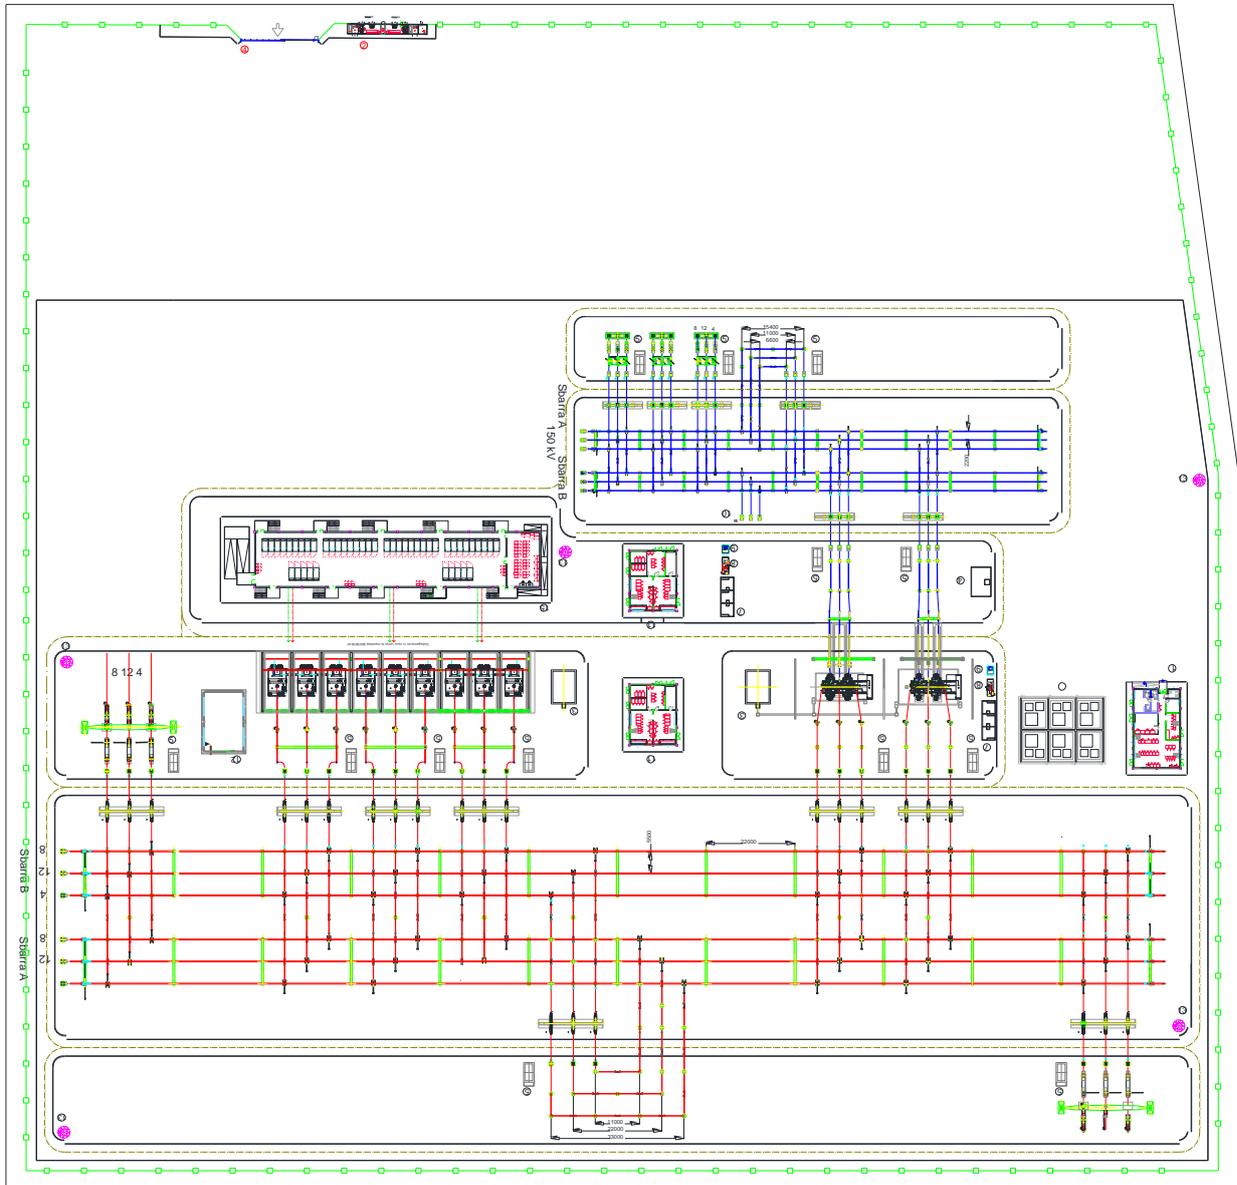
PLANIMETRIA ELETTROMECCANICA GENERALE
